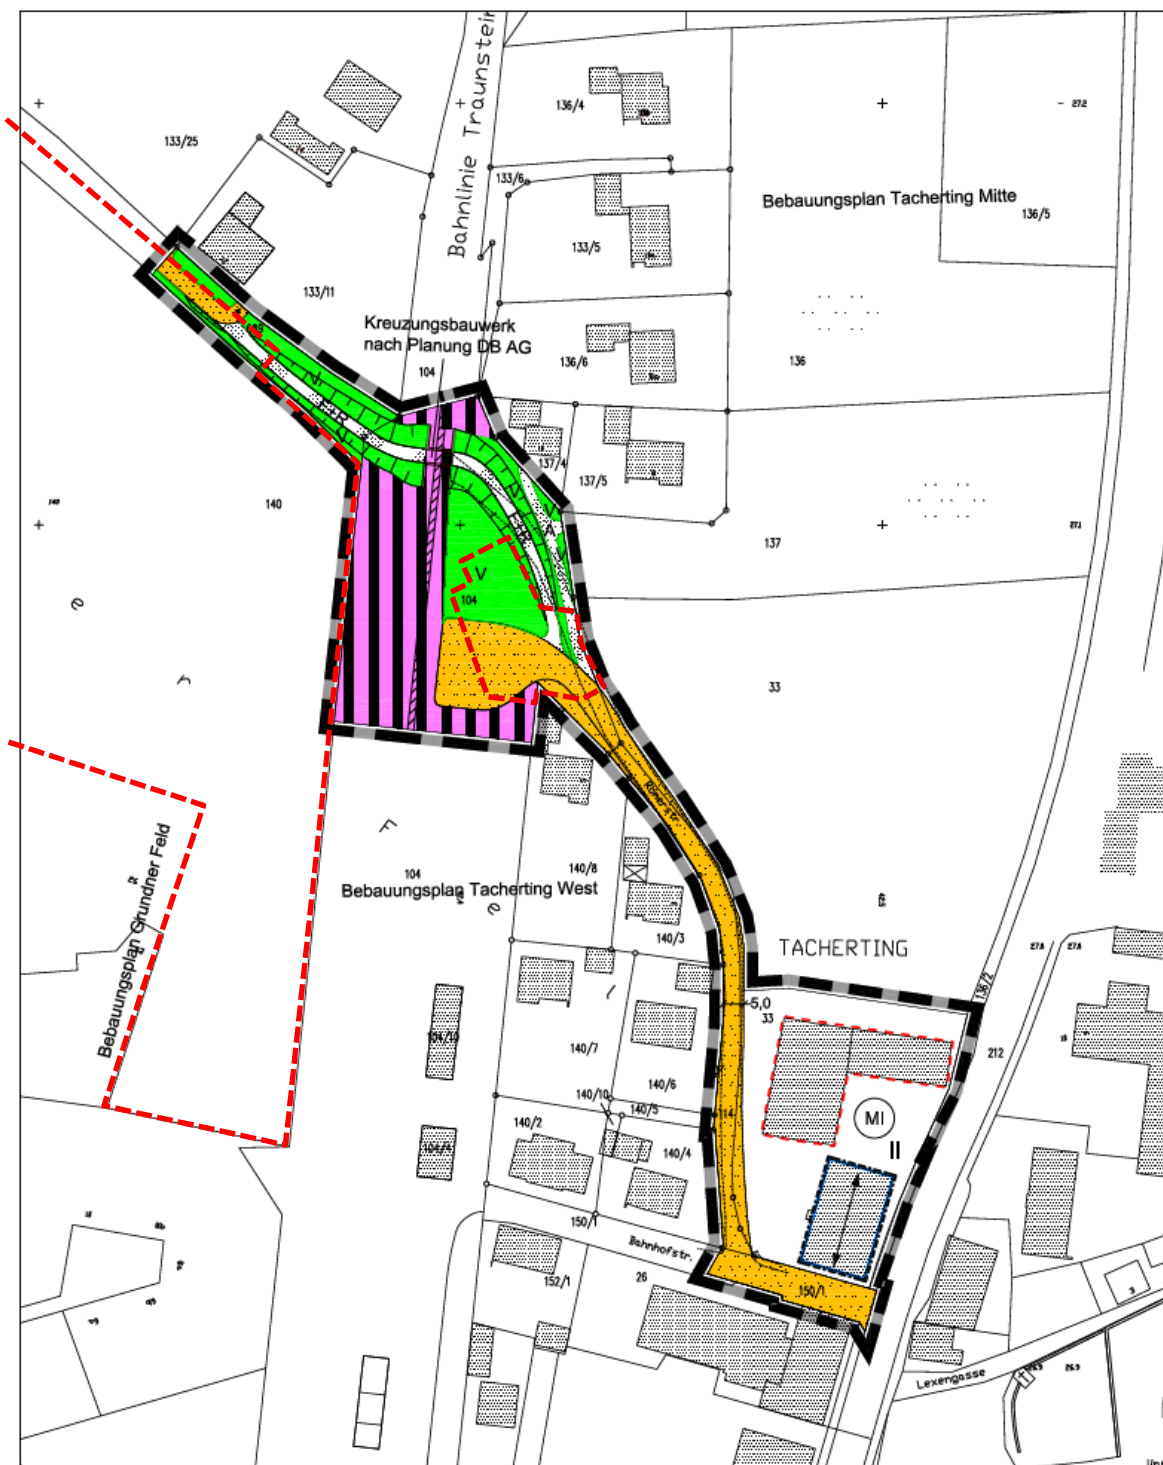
„Teilbereich 4: Römerstrasse“ des Bebauungsplans „Bahnübergänge“ der Gemeinde Tacherting (Geltungsbereiche des gegenständlichen Bebauungsplans rot) - ohne Maßstab
